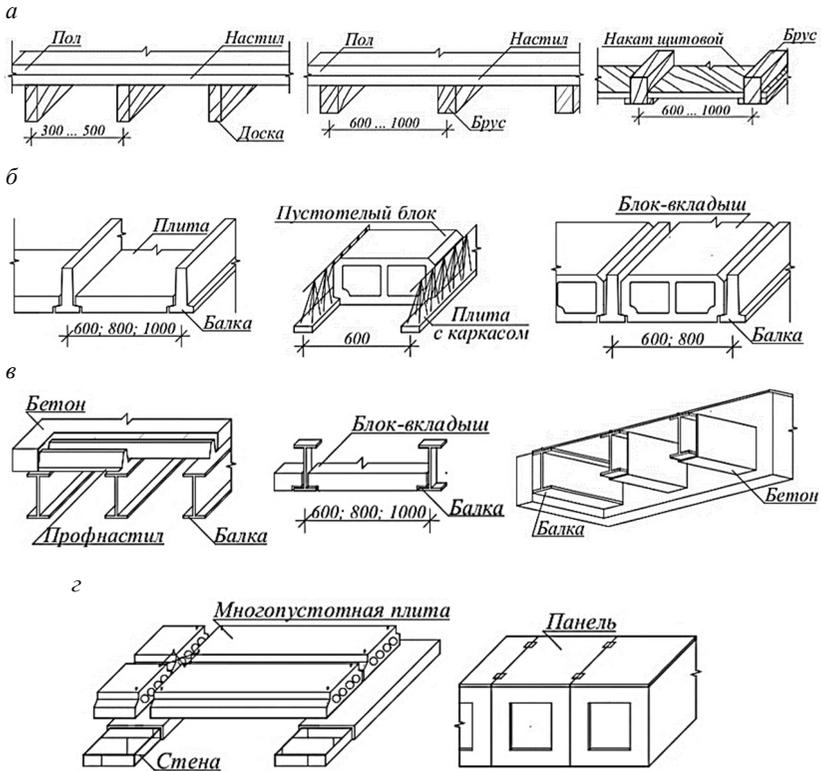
Перекрытия гражданских зданий: *а* — по деревянным балкам: из доски и бруса, с настилом и межбалочным накатом; *б* — по железобетонным балкам: сборным и сборно-монолитным, с межбалочной легкобетонной плитой и блоком-вкладышем; *в* — по металлическим балкам: сборные с легкобетонной плитой, монолитные по несъемной опалубке; *г* — сборные железобетонные: плиты (с опиранием на две стороны) и панели (с опиранием по контуру)
